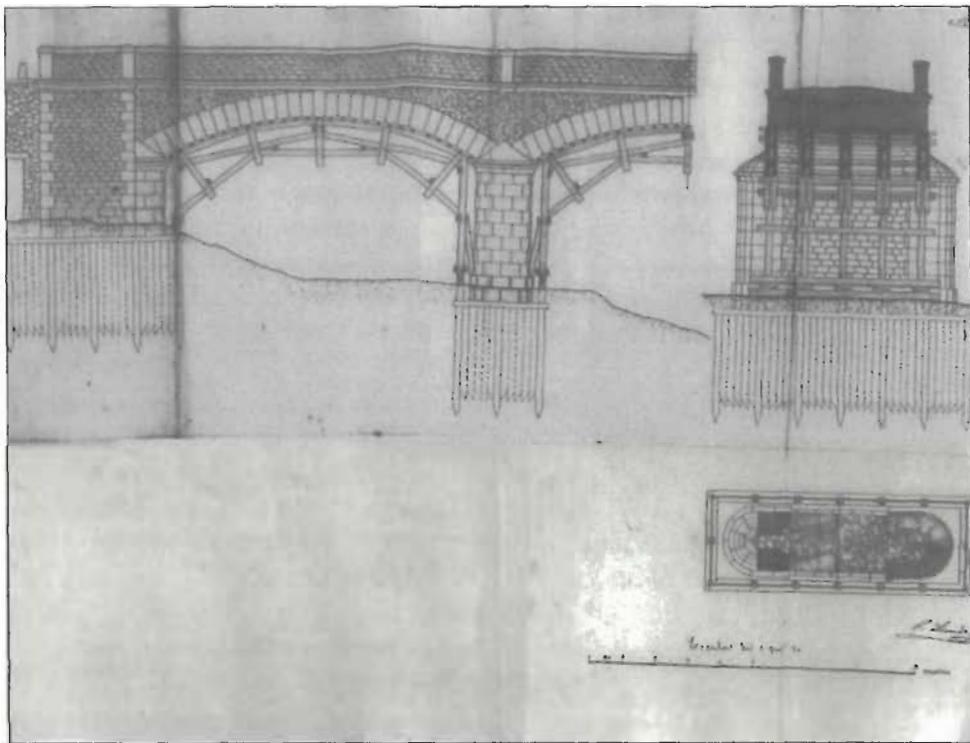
Puente de Ampuero-Marrón, proyecto de Pascual Landa(1871).
